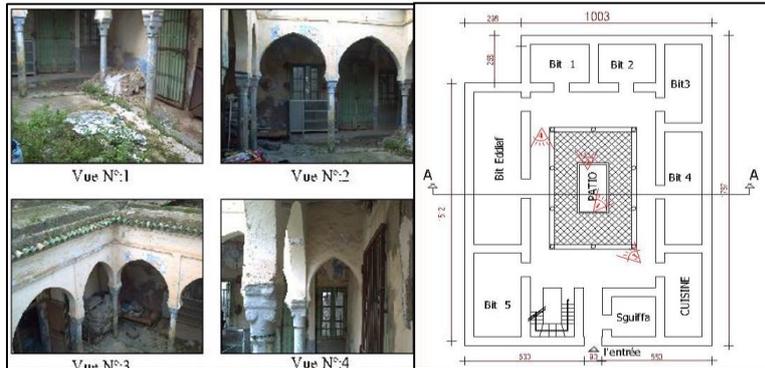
photo et plan de la 1ère maison relevé, source : travaux précédent
